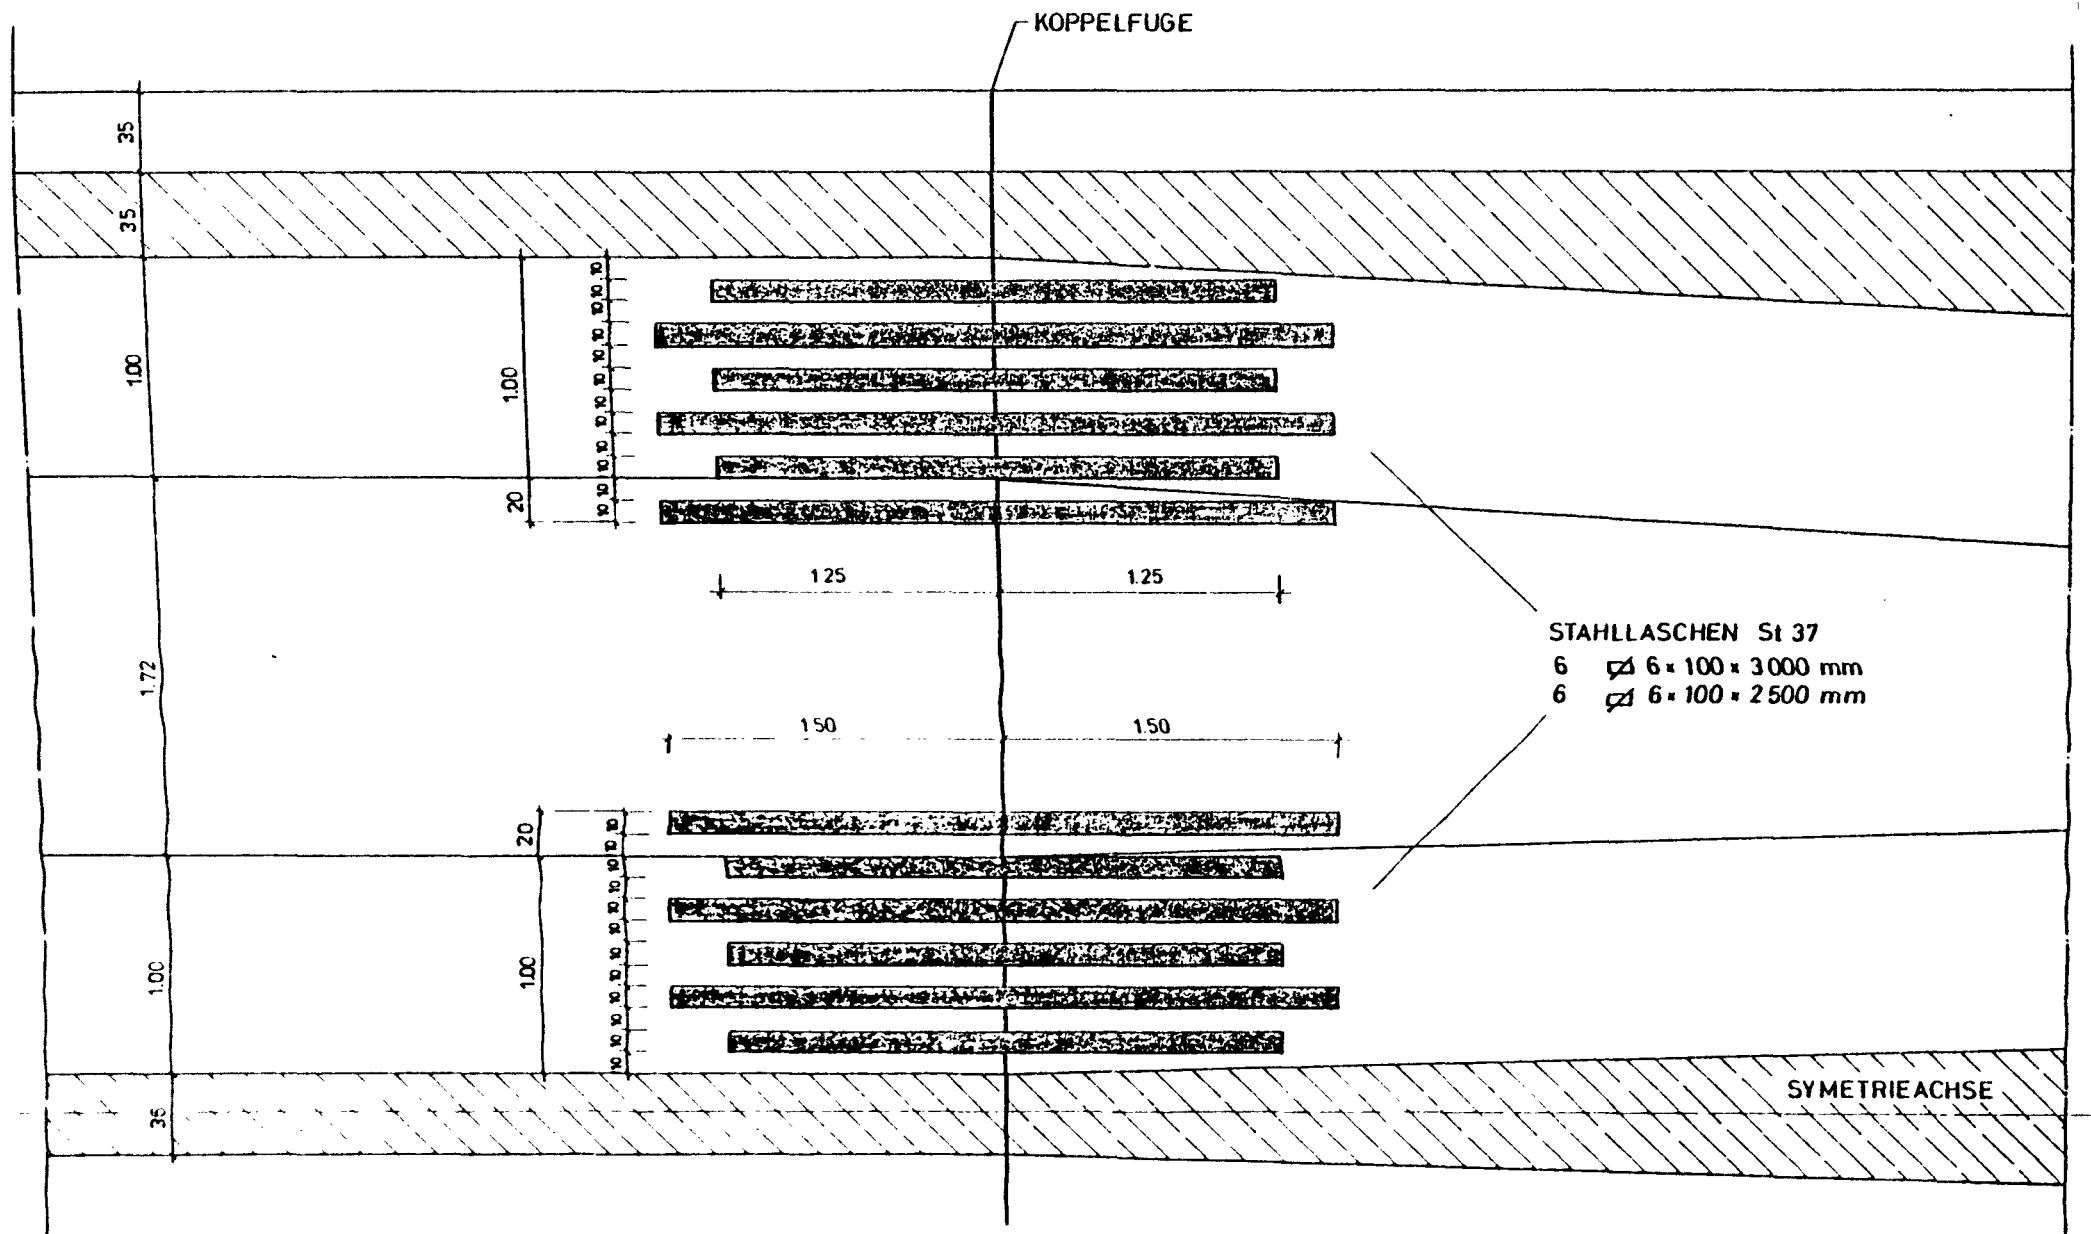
Laschenbewehrungsplan für die Sanierung eines gerissenen Koppelfugenbereiches
